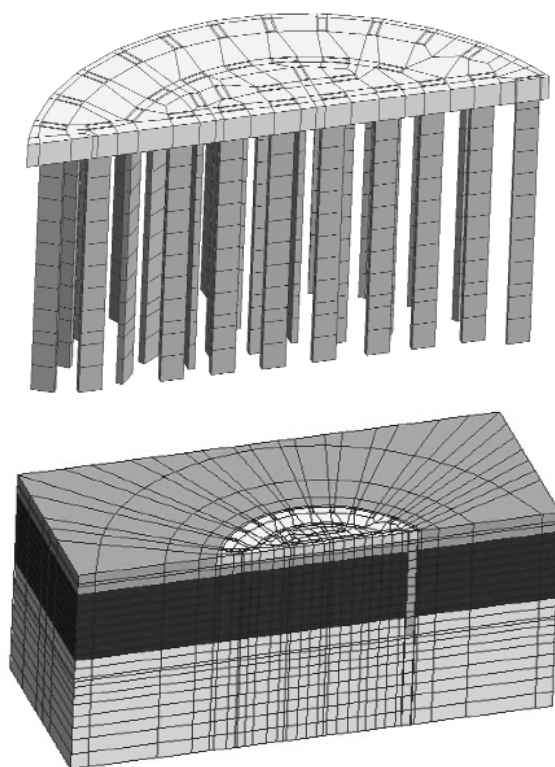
Расчетная модель для расчета фундамента методом конечных элементов
